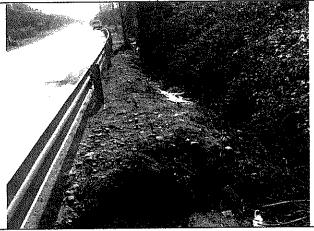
Calzada de asfalto con grietas, kilómetro 5,4, camino rol G-40. (21-08-2013)
